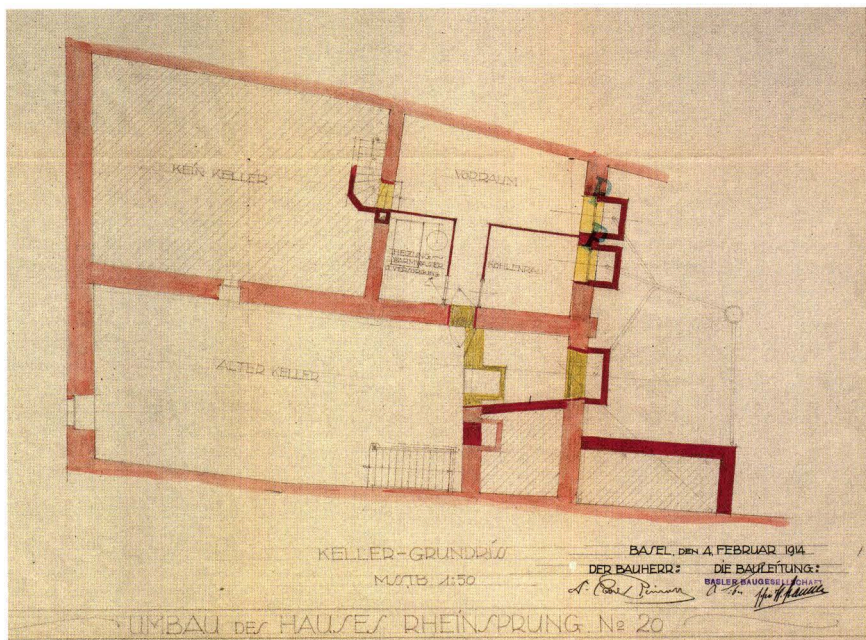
Rheinsprung 20 (2005/13). Grundriss Keller. Der Umbauplan von 1914 zeigt den Bestand mit dem grossen (zweigeschossigen) Keller des Nordhauses (unten) und dem rückwärtigen Keller des Südhauses, dessen vorderer Teil nicht unterkellert ist, und die geplanten Bau-massnahmen. Hellrot das bestehende Mauerwerk, rot die neu hinzugefügten Teile und gelb alle Mauerabbrüche bzw. Ausbrüche. Im Keller Nord sind der Abbruch der Hälfte der Rückmauer und damit verbunden ein Durchgang zum Südkeller sowie der Einbau eines Fensters in der Hinterfassade eingezeichnet, im Südkeller der Einbau von zwei Kellerfenstern und ein zusätzlicher Kellerabgang ausserhalb der Vordermauer. – Baubehörden WW67, StaBS Bauplanausgabe.
